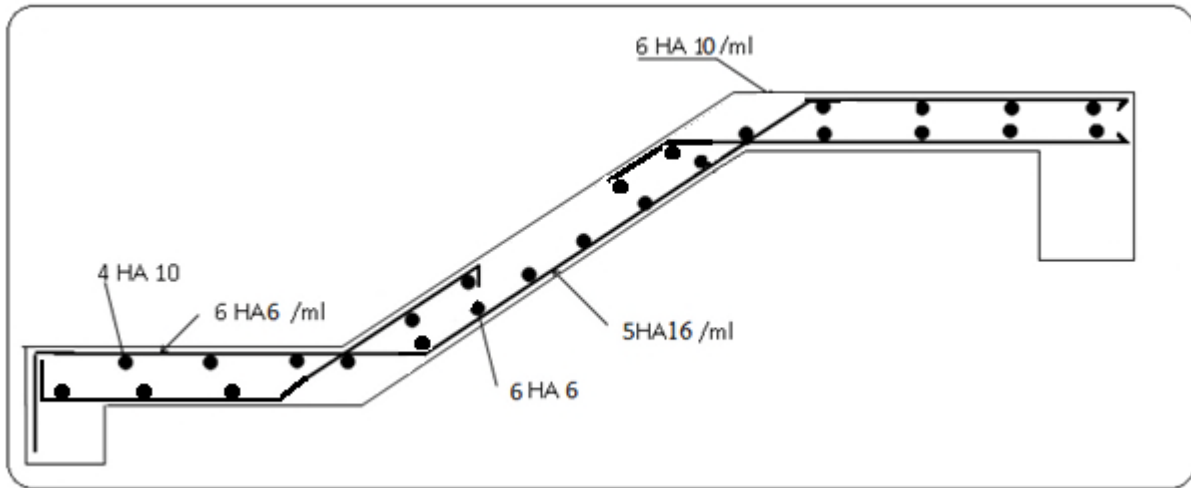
Schéma de ferrailage de l'escalier.
